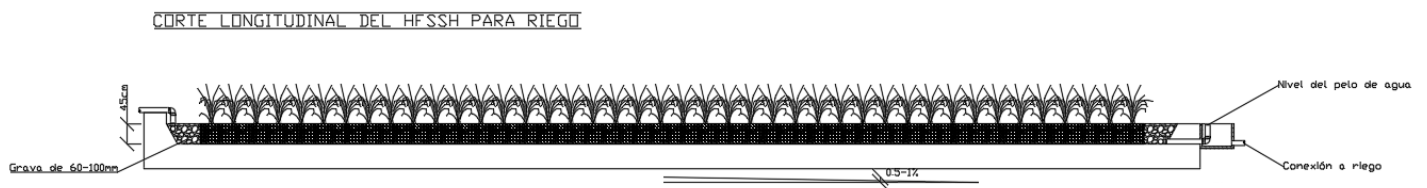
NOTA: PLANO DEL HFSSH PARA REÚSO EN RIEGO. ELABORACIÓN PROPIA
